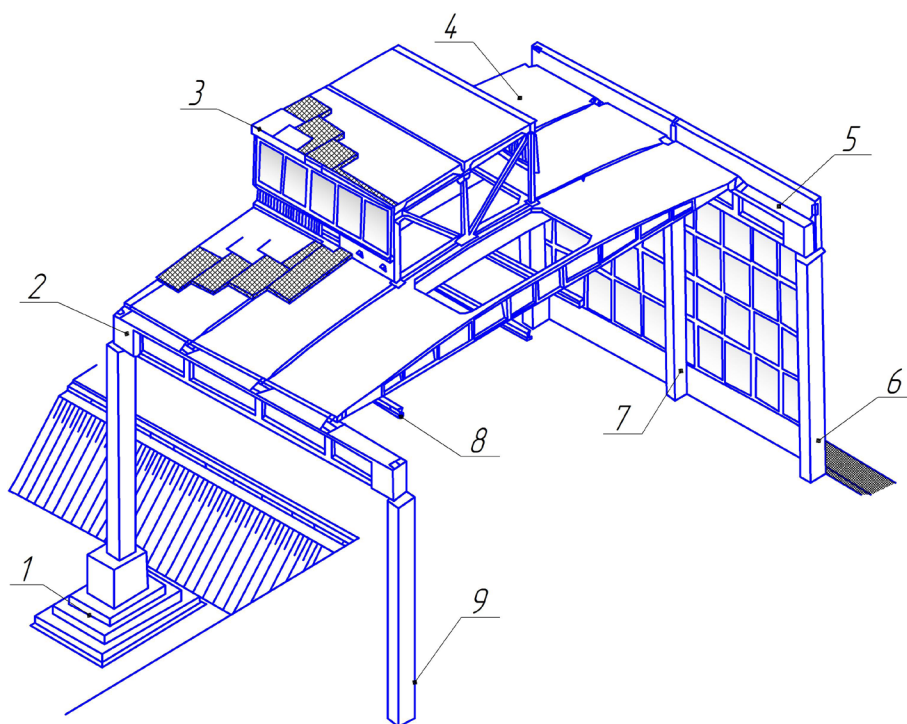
Строительная конструкция одноэтажного промышленного здания:
